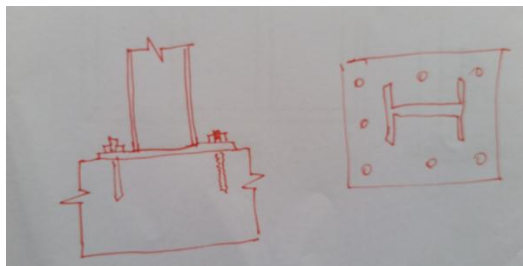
EXPLICACION UNION DE COLUMNA DE CONCRETO CON COLUMNA METÁLICA.
